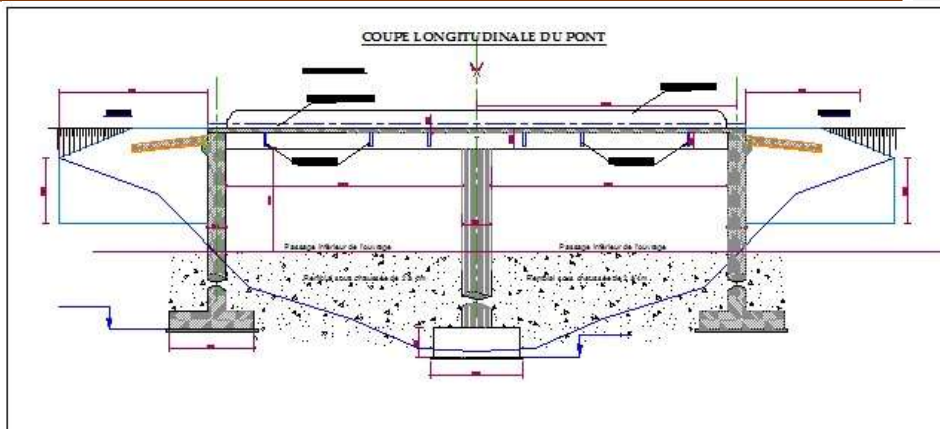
Coupe longitudinale de l'ouvrage projeté
